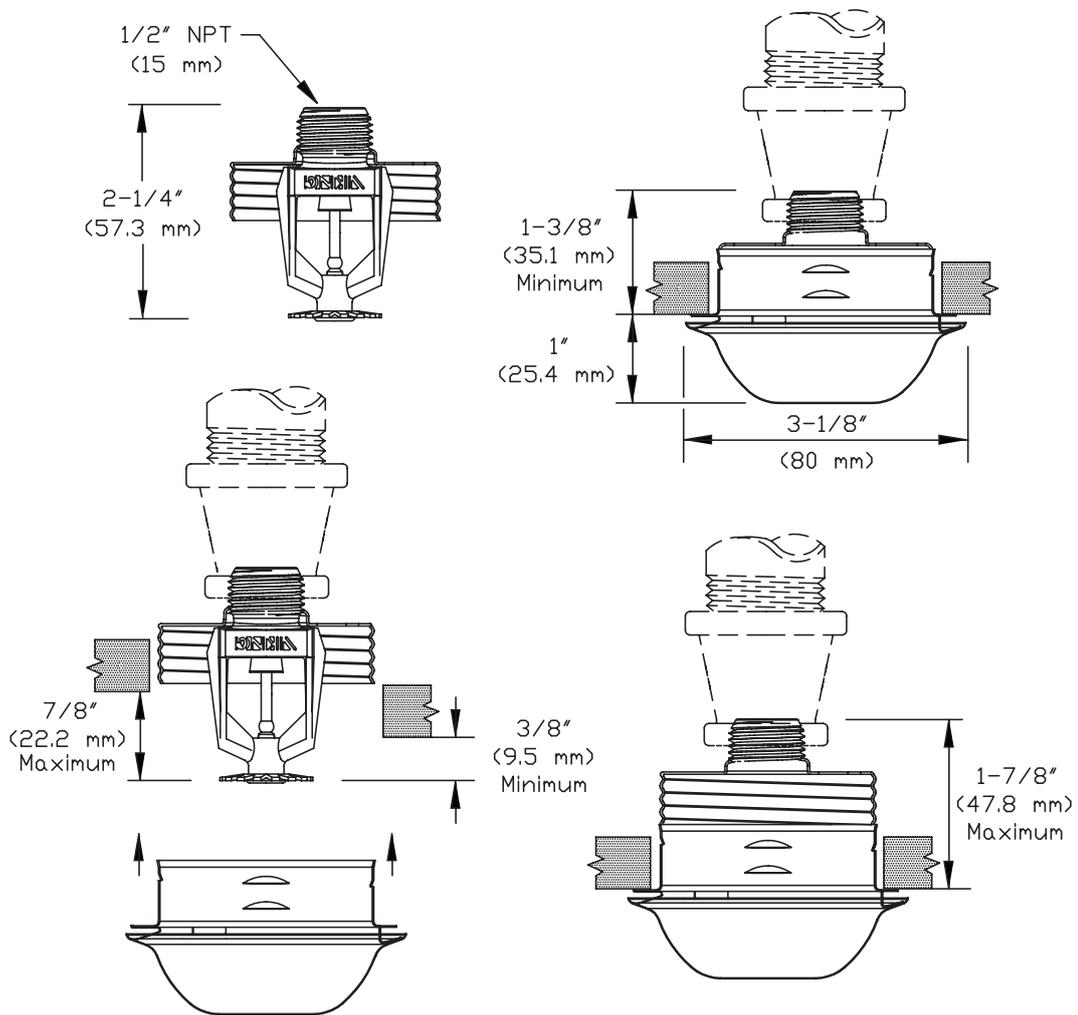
Maße des verdeckten Sprinklers VK302 und Einbau der Abdeckung
